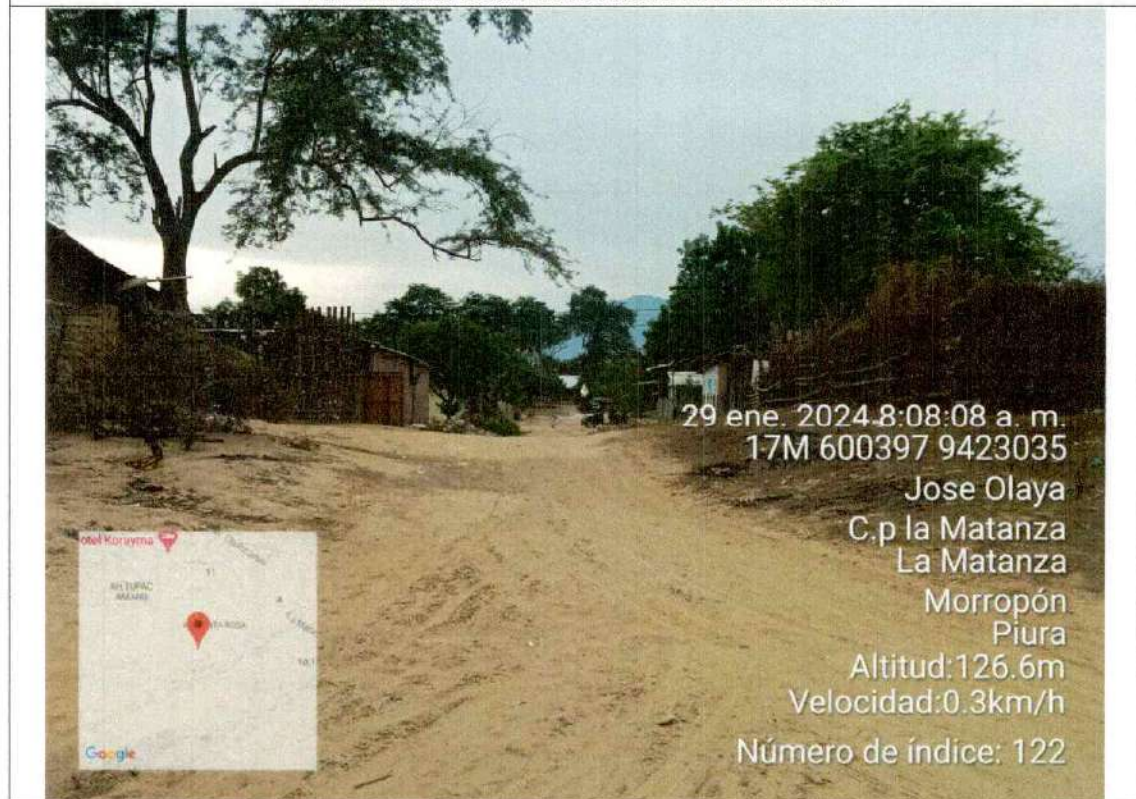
Vista de la calle 05 del A.H. Santa Rosa
